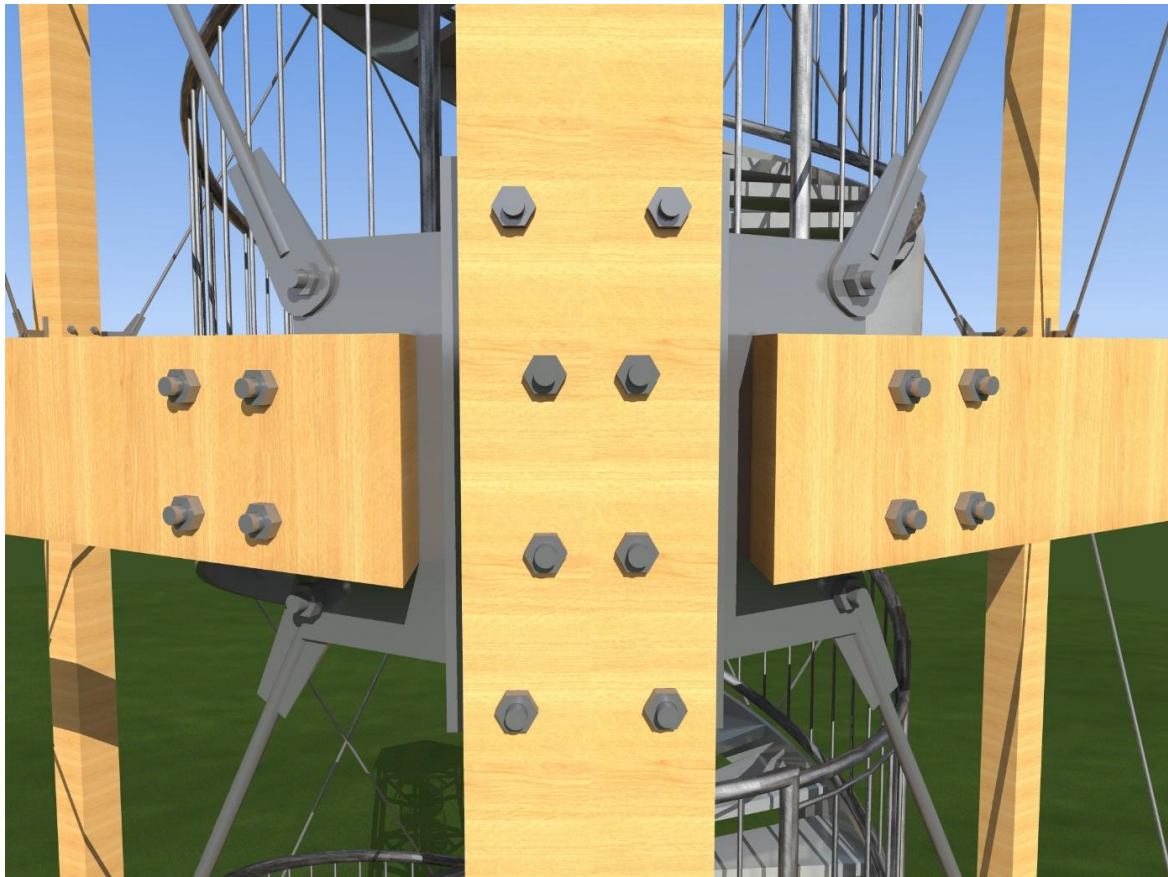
dřevěná konstrukce – perspektiva shora
